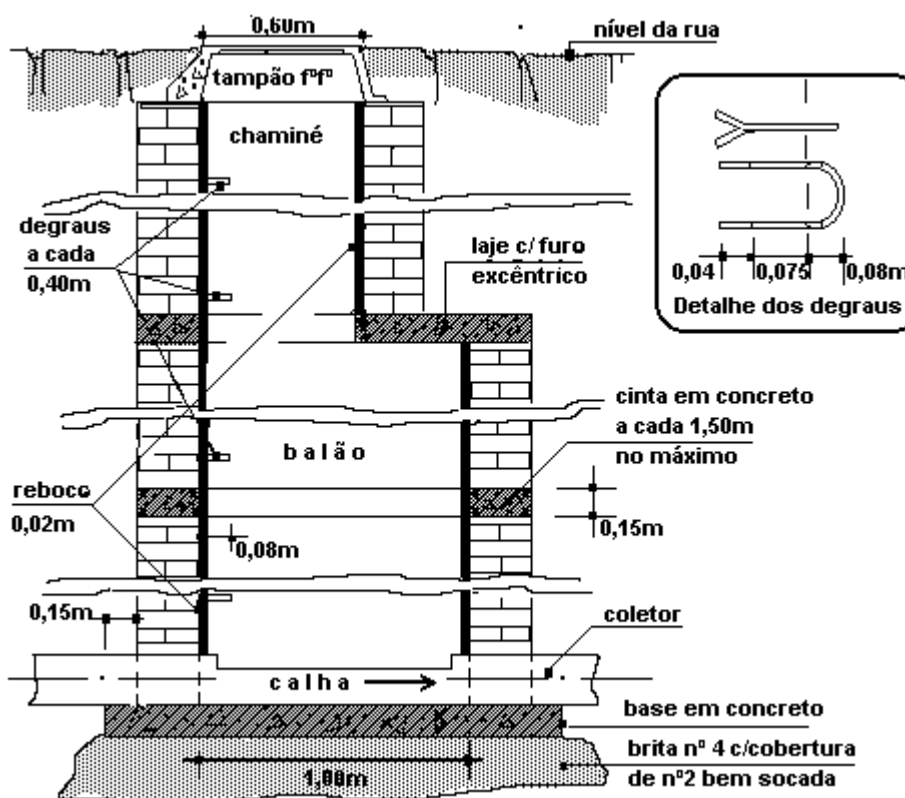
Poço de visita em alvenaria de tijolos
